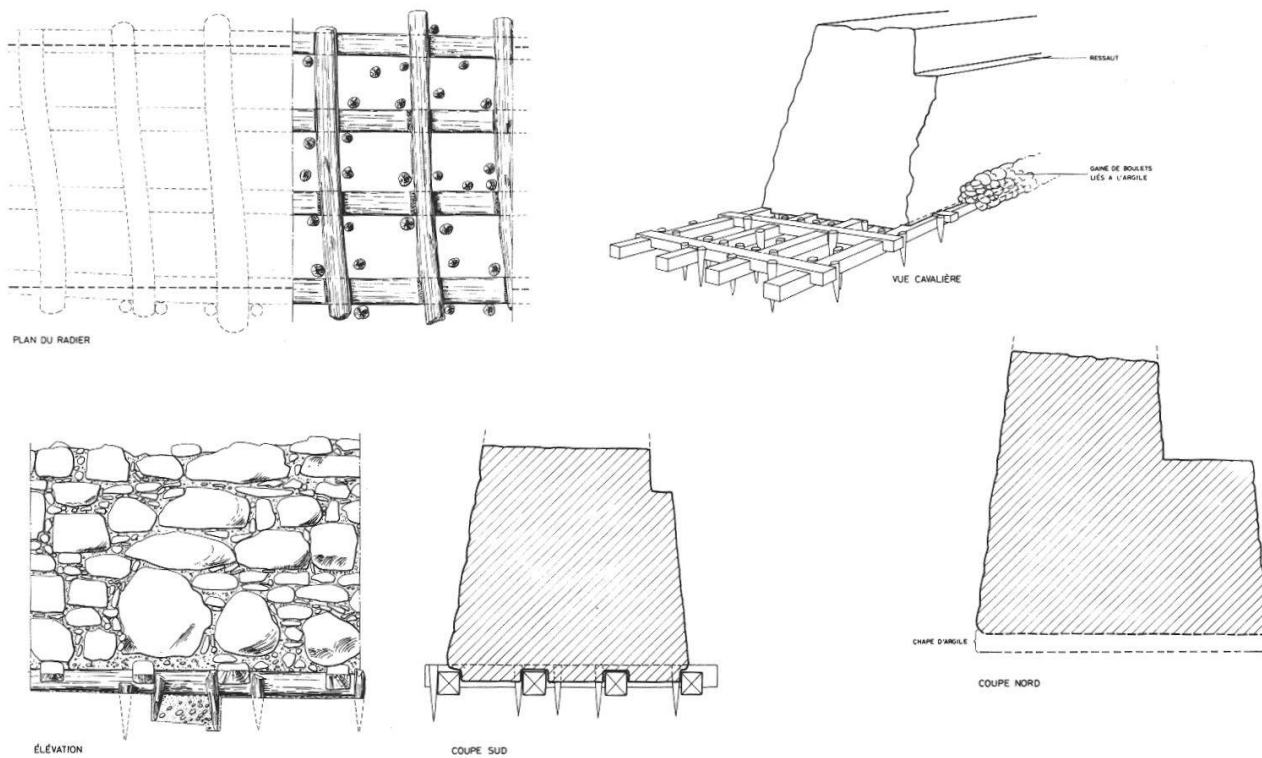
Vevey – Saint-Antoine – Plan, élévation, coupe et vue cavalière de la structure de la digue de la Veveysse (1682-1683). Maçonnerie et radier de poutres.
